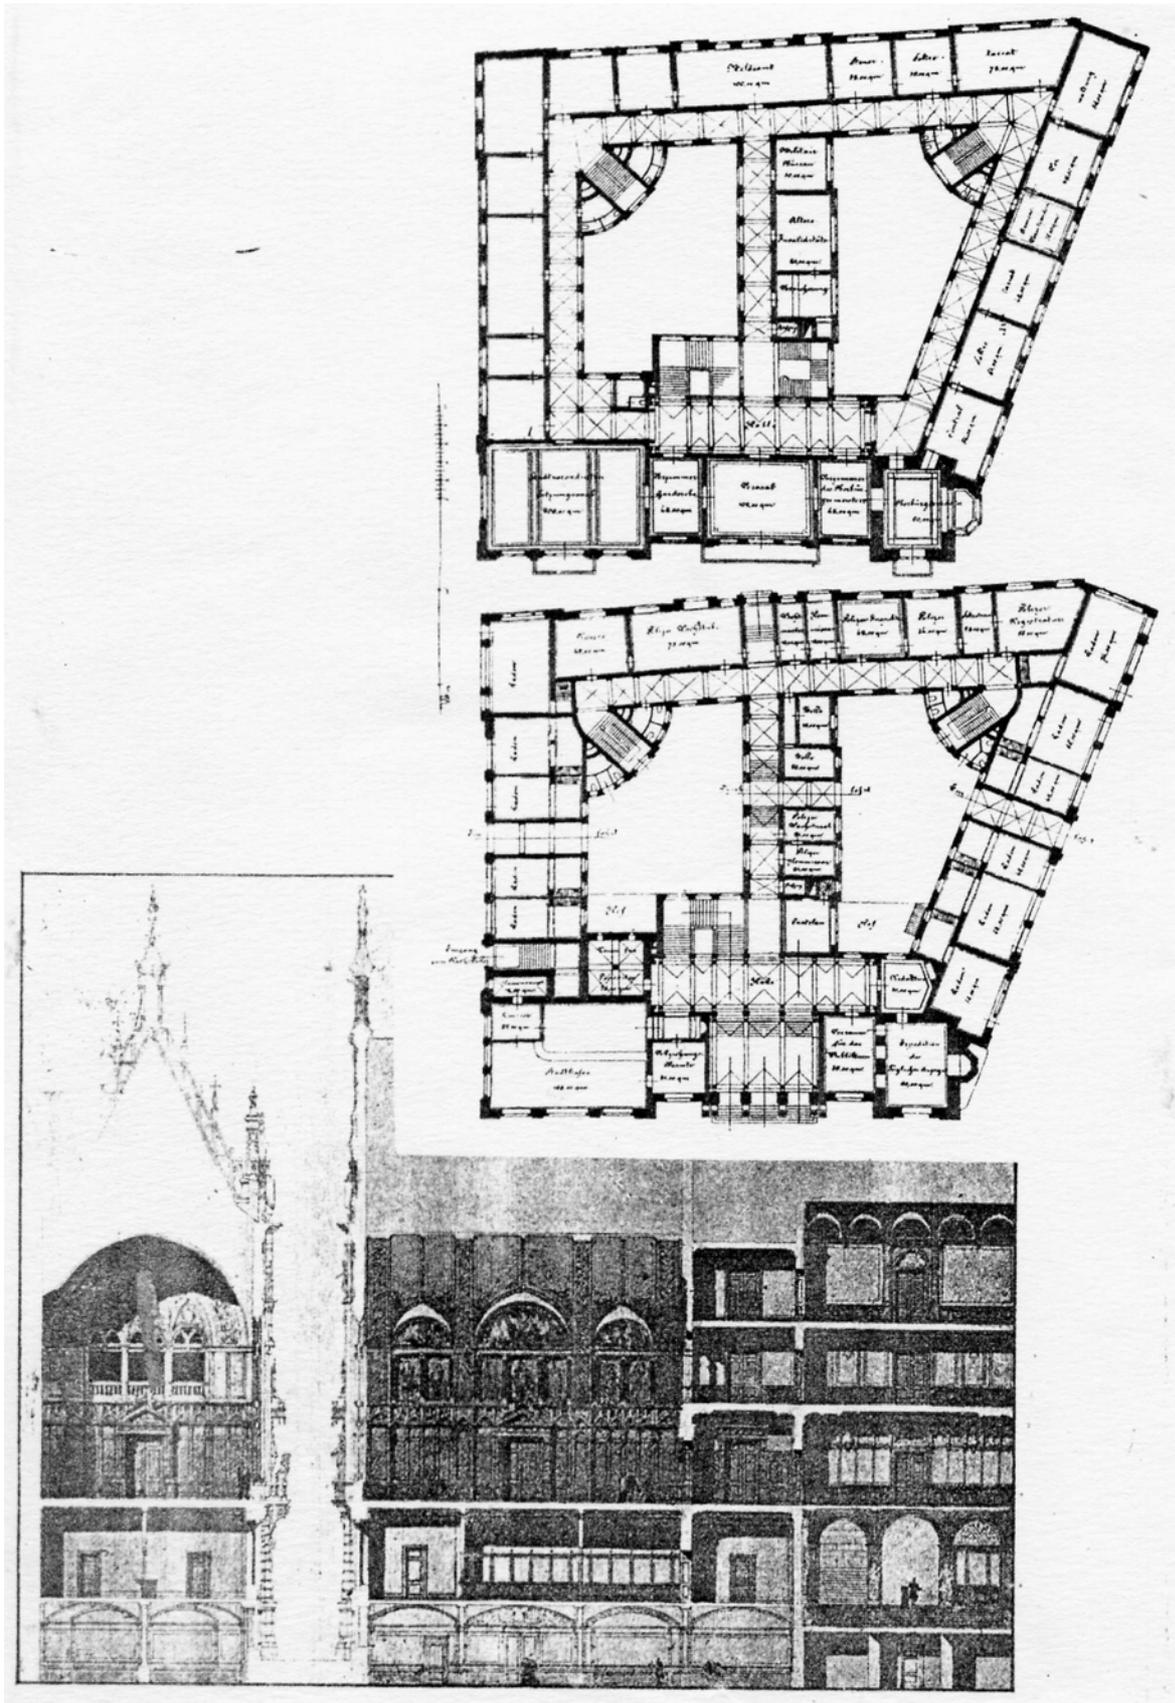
H. Plange und F. Hagenberg, Rathaus Elberfeld, Grundriss und Schnitt, 1894
